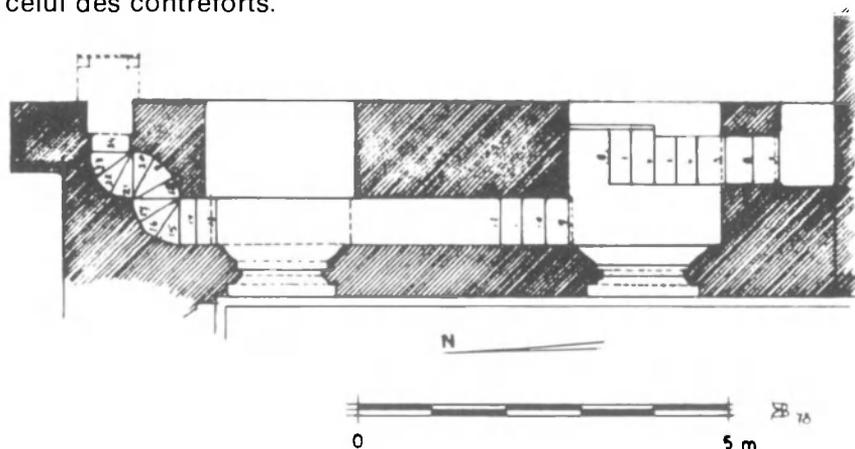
Paroi ouest du croisillon sud : plan de la galerie intérieure.
